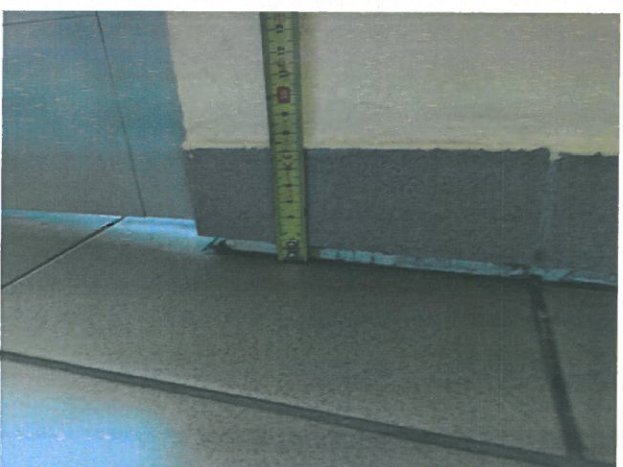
,6 – Lokalnie zapadnięta posadzka na wysokości około 12 mm.
